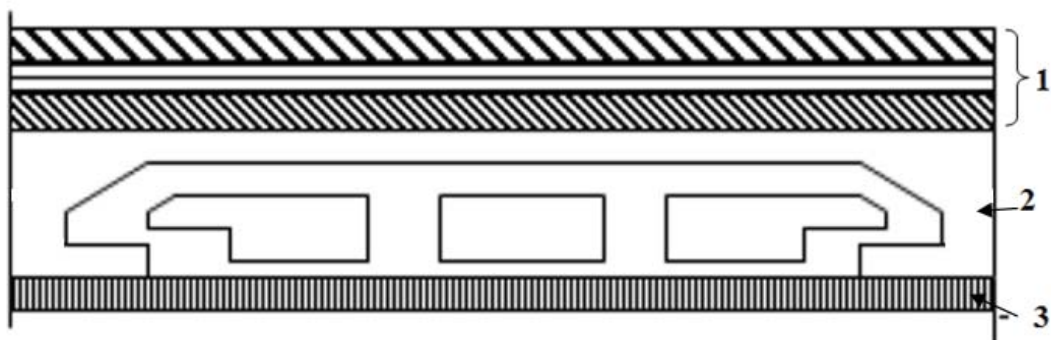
coupe transversale d'un plancher terrasse inaccessible.
